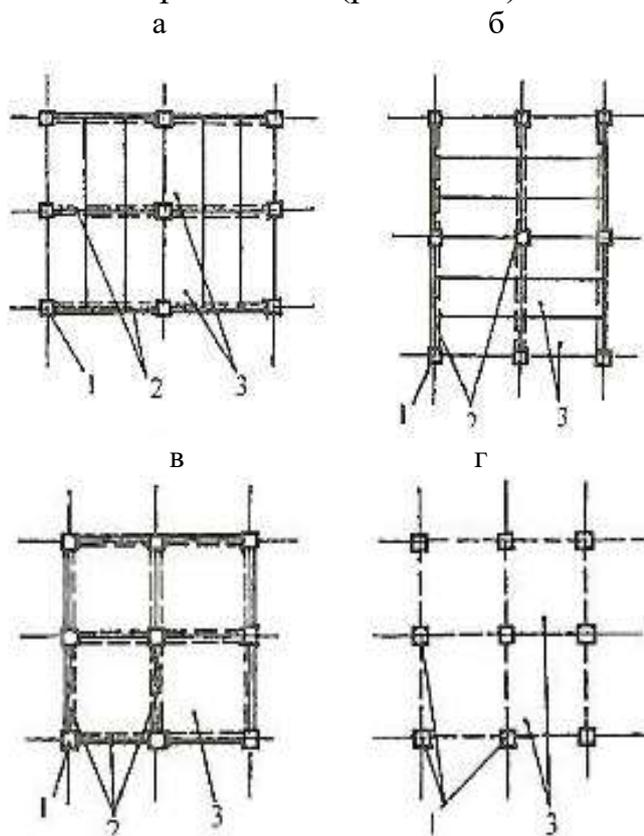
Каркасные конструктивные схемы: а — с продольным расположением ригелей; б — с поперечным расположением ригелей; в — с перекрестным расположением ригелей; г — безригельное решение; 1 — колонны каркаса; 2 — ригели перекрытия; 3 — плиты перекрытия
